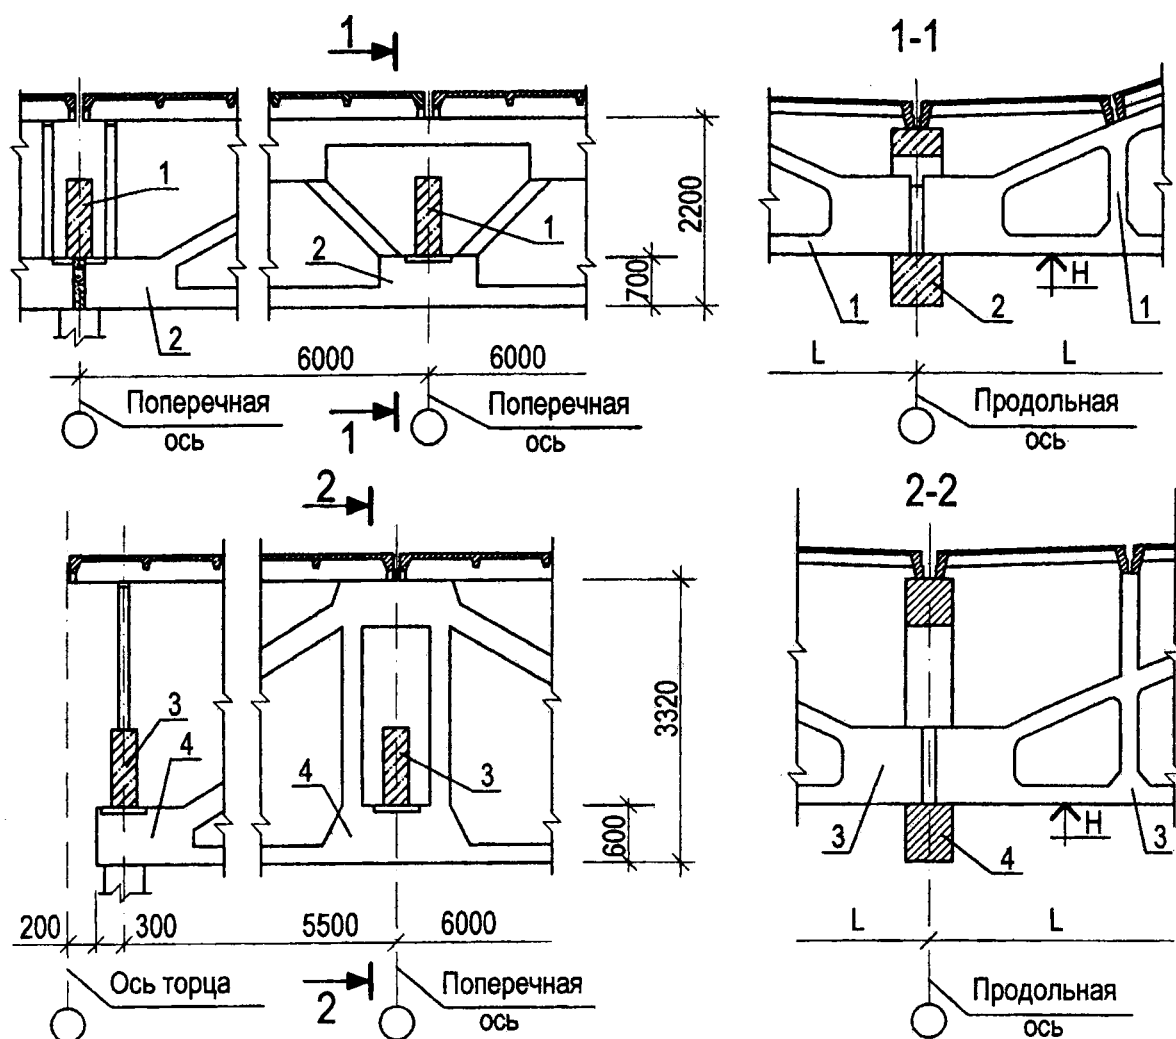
Опираие стропильных ферм на подстропильные:
